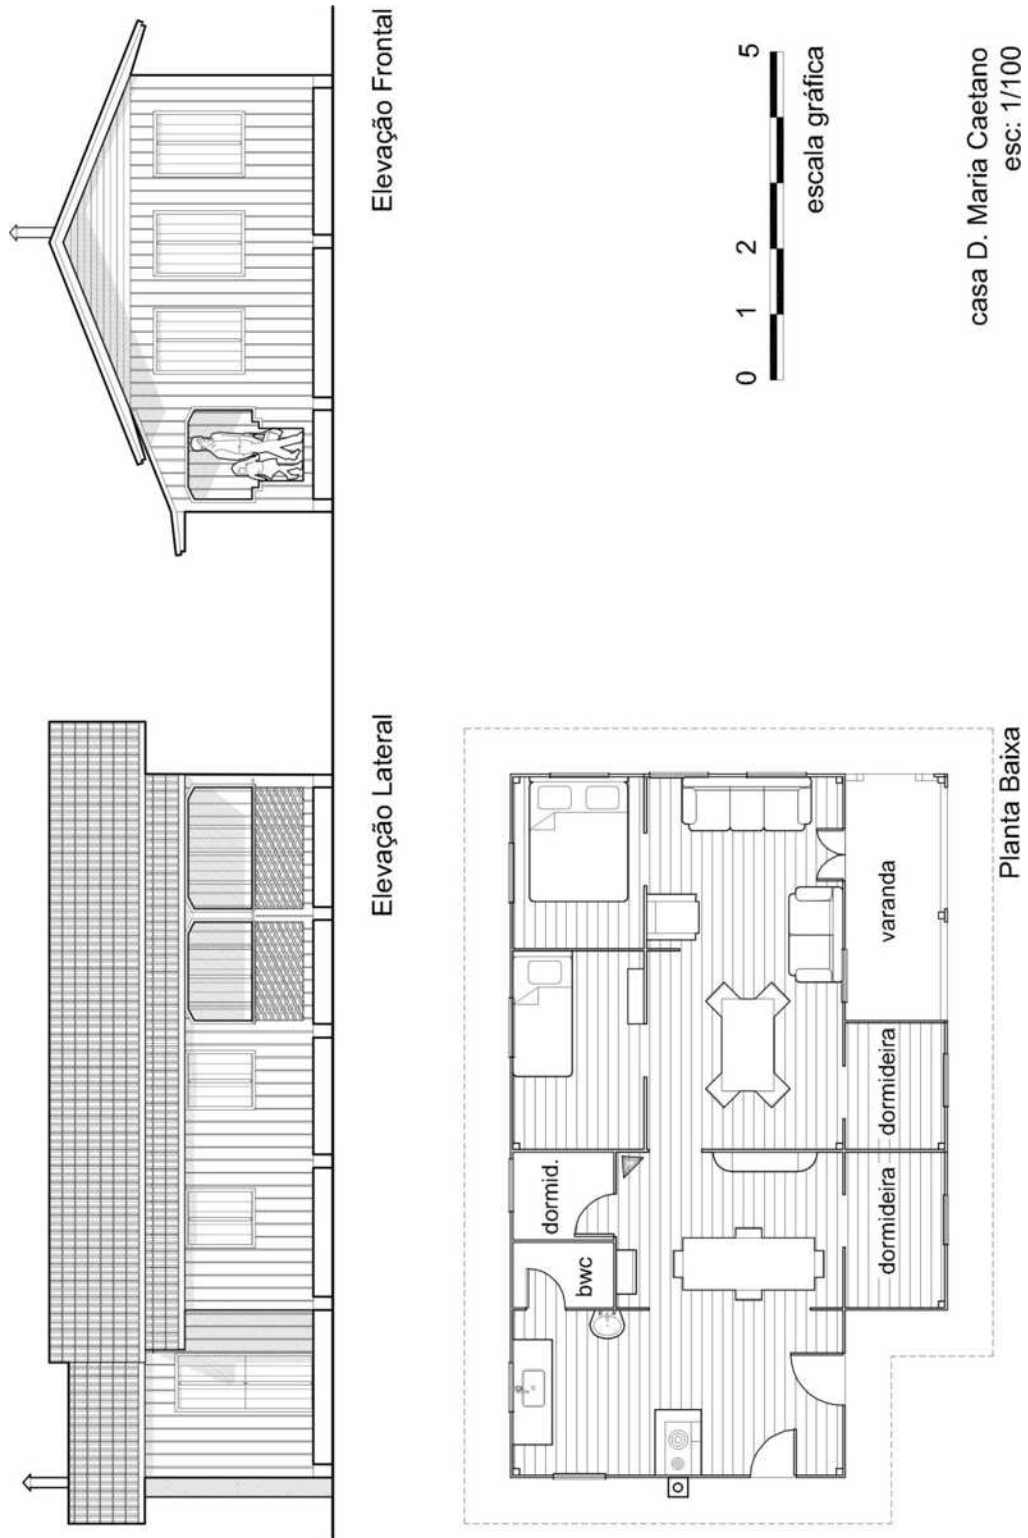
Casa da D. Maria Caetano – desenhos técnicos do levantamento.
